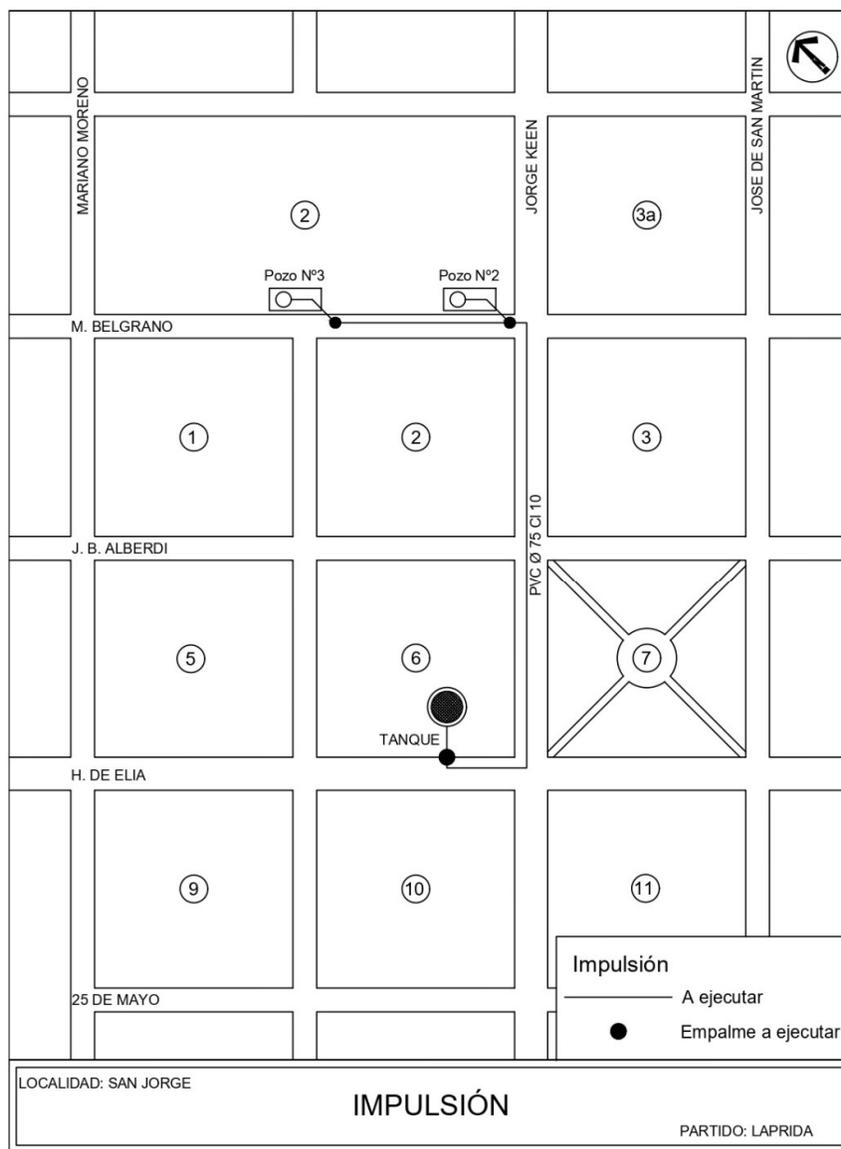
planos para la traza de cañerías y perforaciones proyectadas
